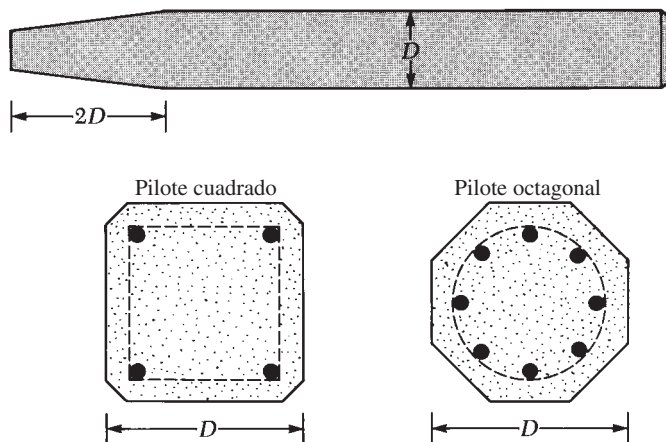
Pilotes prefabricados con refuerzo ordinario
